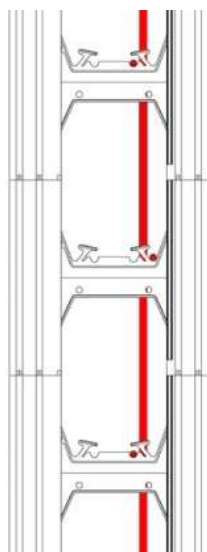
Armadura vertical cruzada, entre a armadura longitudinal previamente colocada nas ranhuras dos espaçadores em aço (ARGISOL, 2010).
